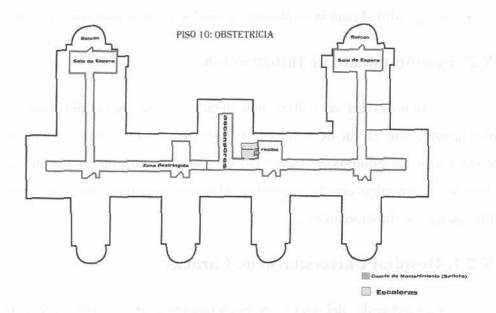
Levantamiento Planimétrico del piso 10. Fuente: Elaboración Propia.
